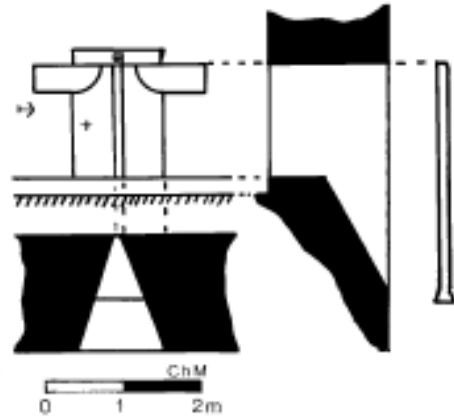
La tour Ronde. Plan, élévation et coupe d'une archère.
